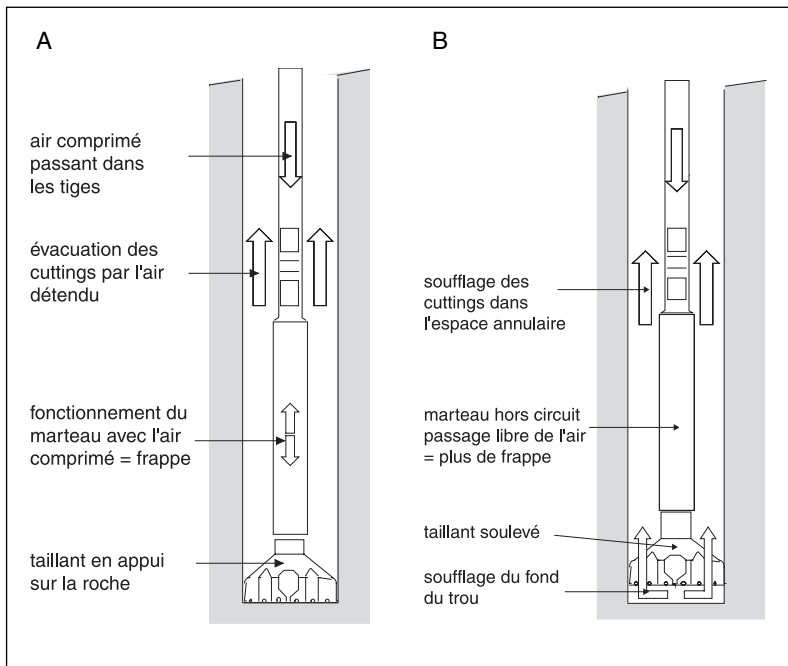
Principe de fonctionnement du marteau fond de trou.
